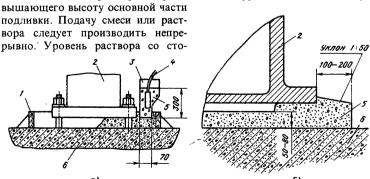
Подливка оборудования с помощью лотка-накопителя:
